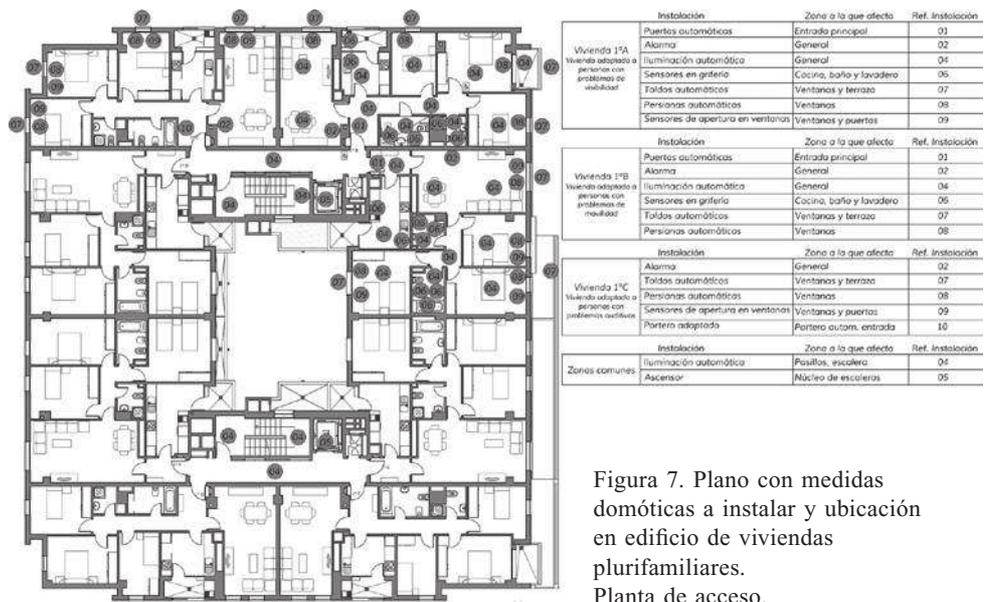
Plano con medidas domóticas a instalar y ubicación en edificio de viviendas plurifamiliares. Planta de acceso.
